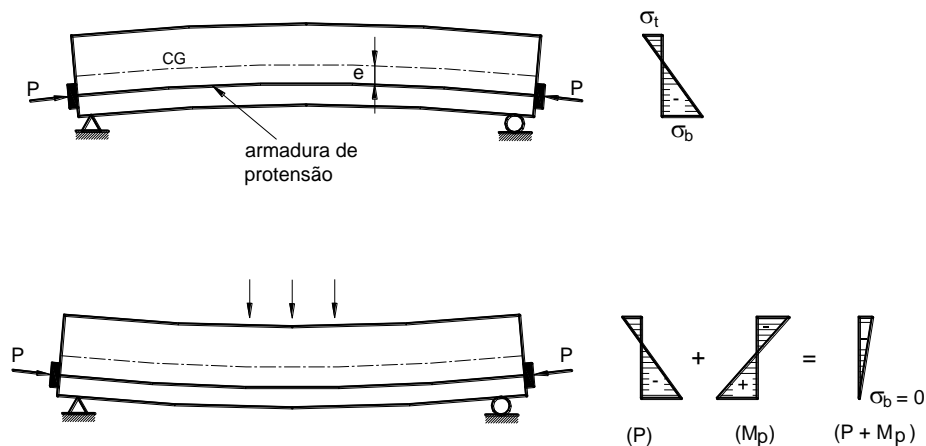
Viga biapoiada em Concreto Protendido (FONTE: LEONHARDT e MÖNNIG, 1982).
